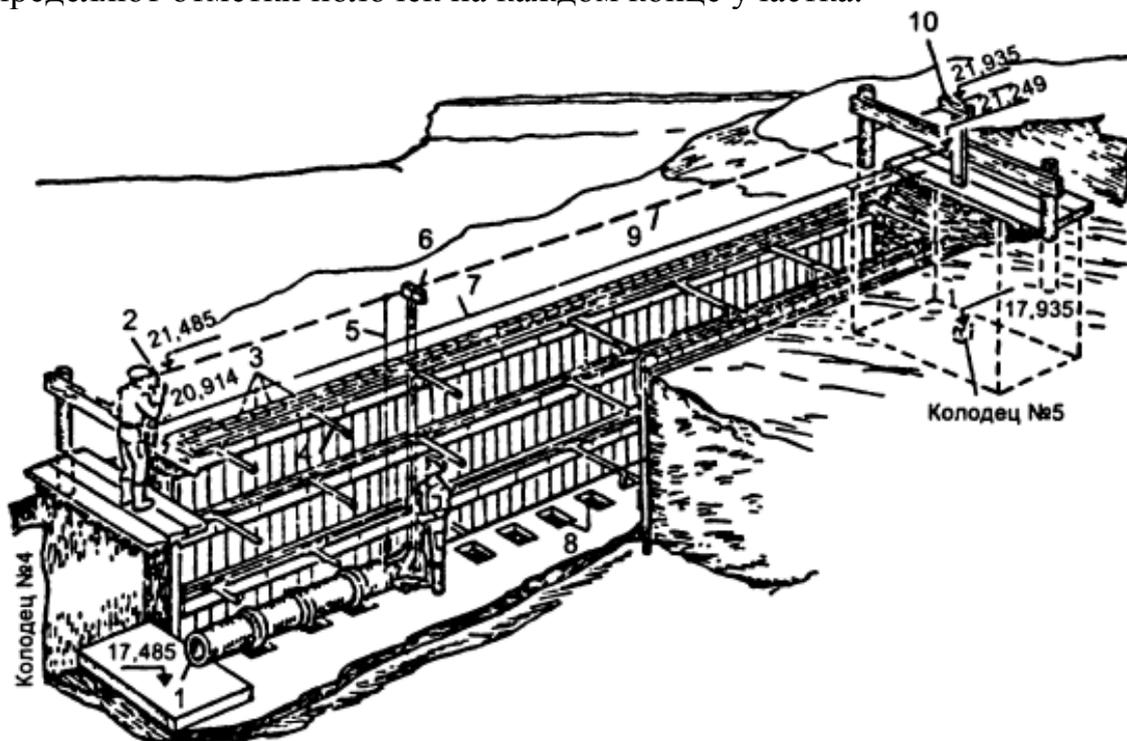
Схема укладки трубопровода по заданному направлению и уклону:
